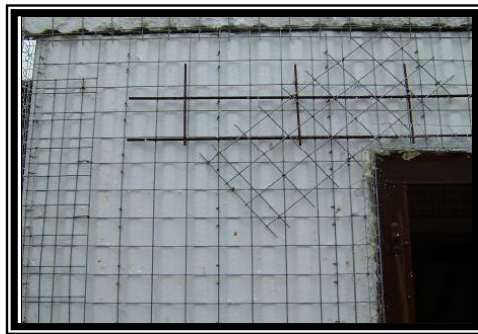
Colocación de mallas adicionales de refuerzo a los Paneles.
